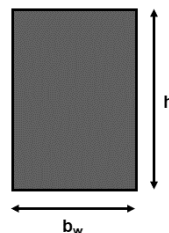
Dimensiones de una Viga. Fuente: Propia
